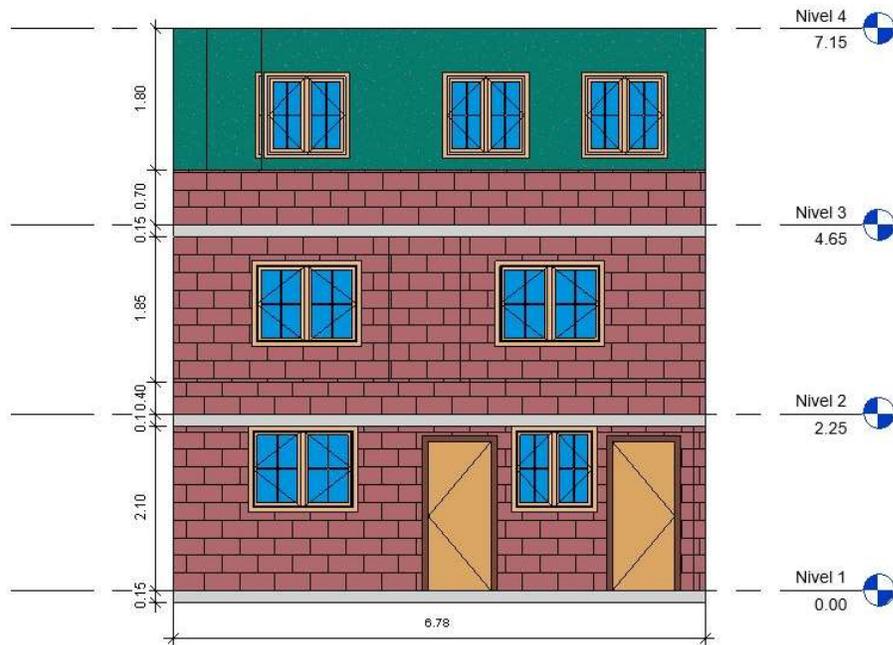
Modelación de Fachada. Fuente: elaboración propia
